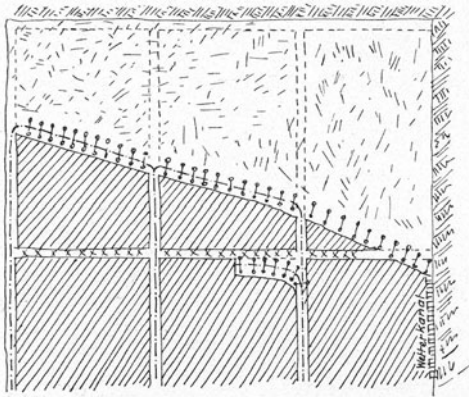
Grundriß einer Breitpfeilerfront mit Streckenübersetzung
